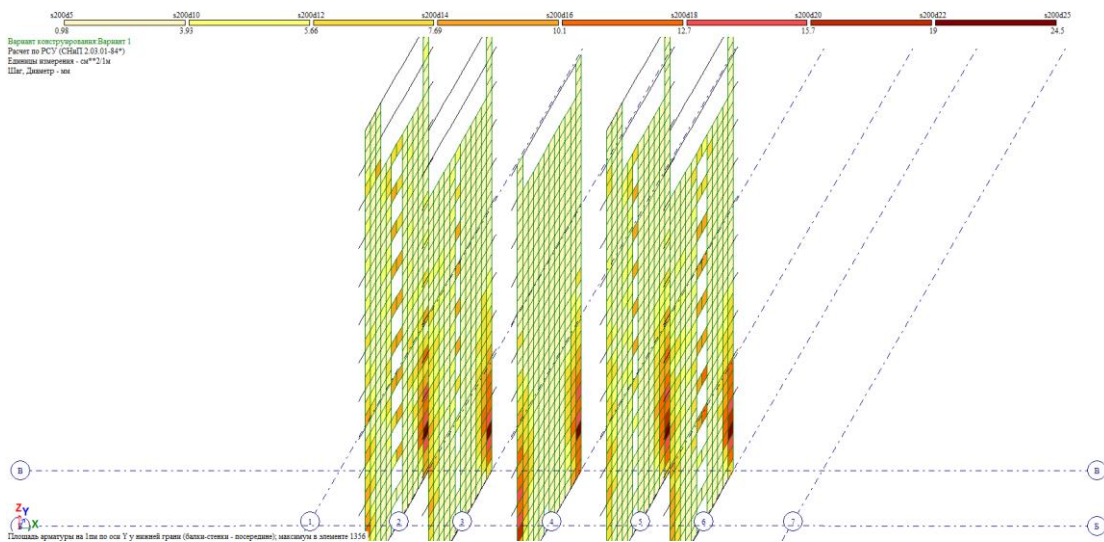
Армирование по оси Y у нижней грани поперечных диафрагм жесткости
